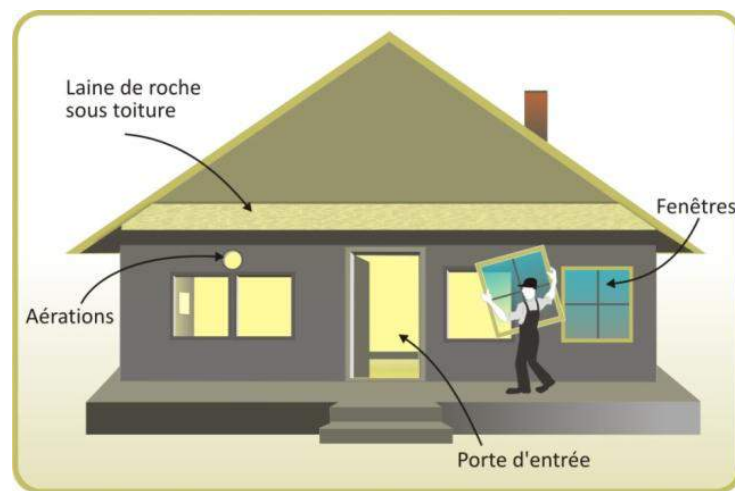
Illustration d'un renforcement de l'isolement de façade d'un logement (Source : Egis)
